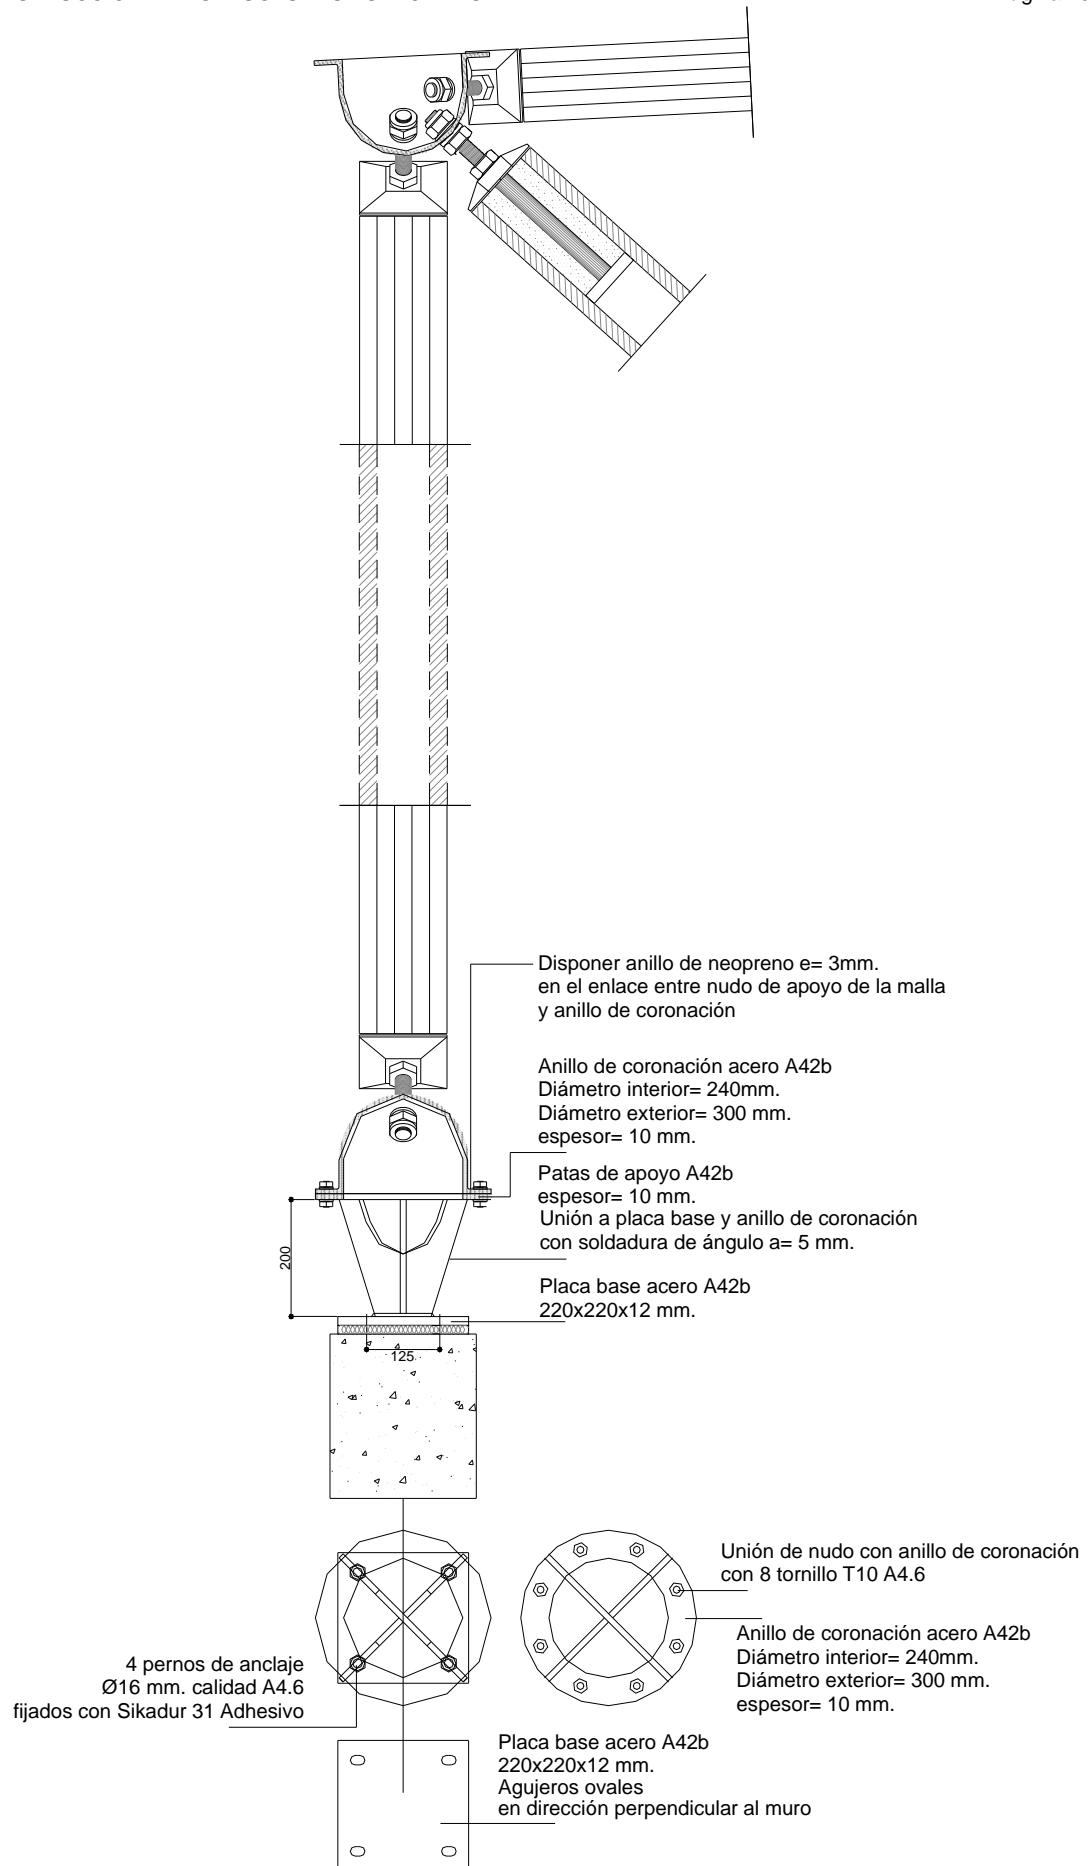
Detalle de apoyo de puntales sobre el muro de hormigón existente
